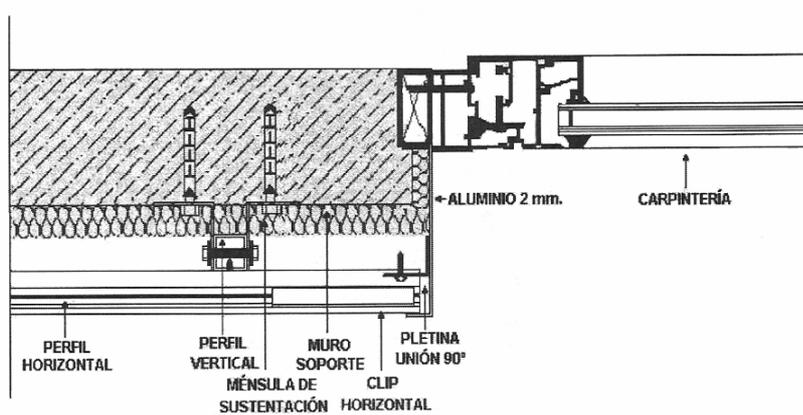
SECCIÓN HORIZONTAL POR RECERCADO METÁLICO.
